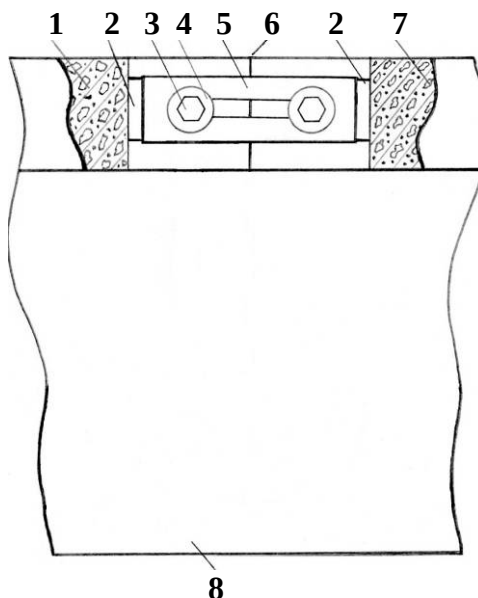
Соединение экранов крышек на большом лотке, вид сбоку на разрез по продольной оси крышек:
